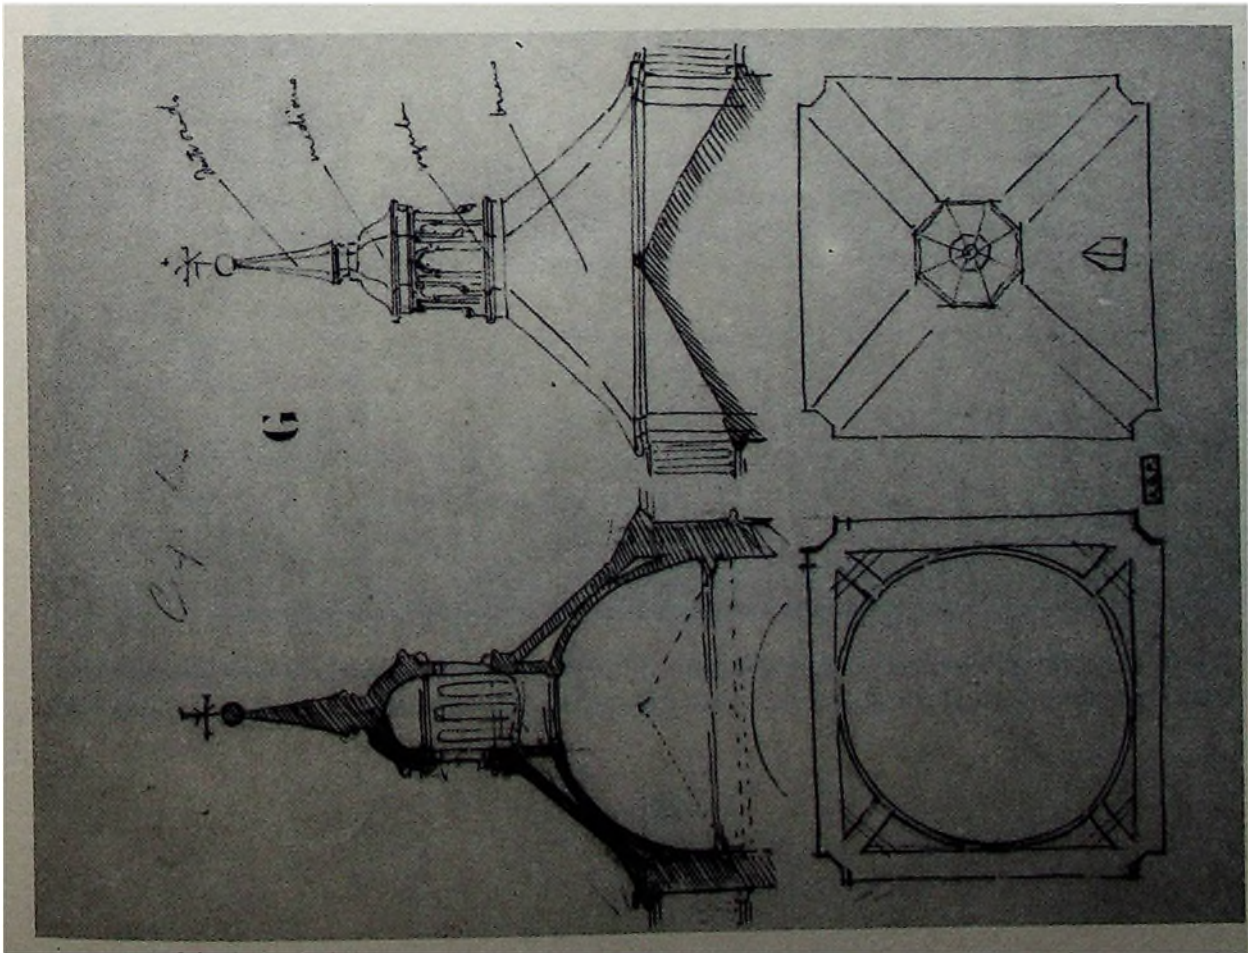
Planta y alzado de las Capillas (A.P.)
